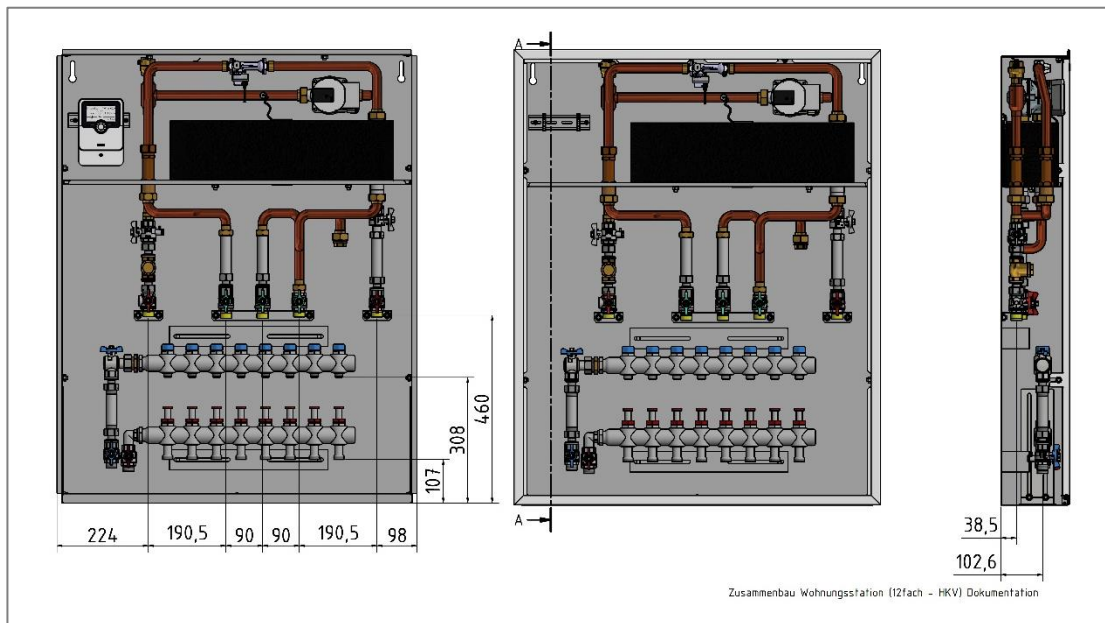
Anschlussmaße Hydraulik (Maße in mm)
